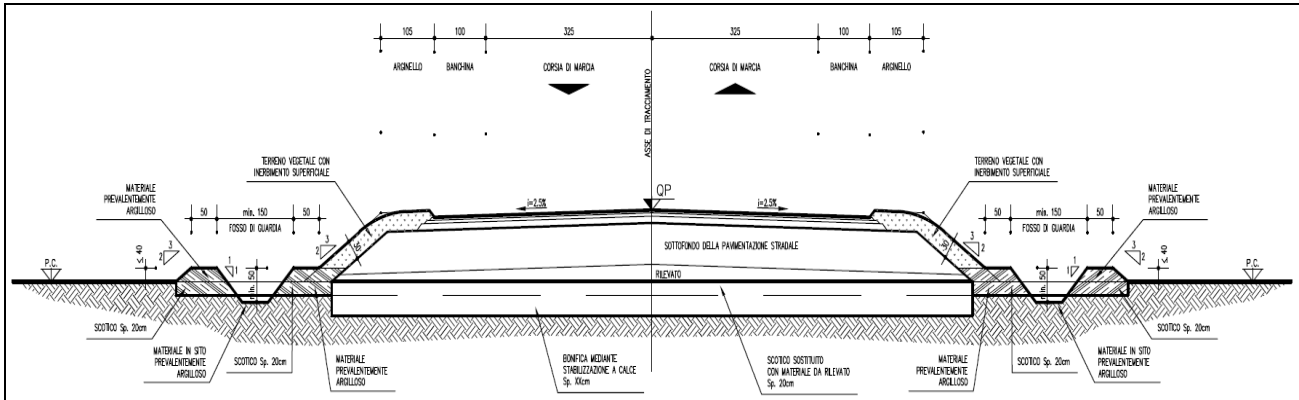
SEZIONE TIPO STRADA COMUNALE BACCARELLA DI NUOVA PROGETTAZIONE
